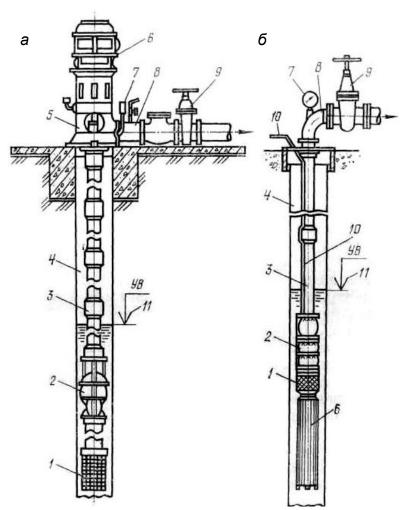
Артезианские насосы: a — полупогружной типа АТН; б — погружной типа ЭЦВ: 1 — фильтр; 2 — насос; 3 — водоподъемный напорный трубопровод; 4 — обсадная труба скважины; 5 — опорная рама (станина); 6 — электродвигатель; 7 — манометр; 8 — напорный патрубок; 9 — задвижка; 10 — силовой кабель; 11 — отметка динамического уровня воды
